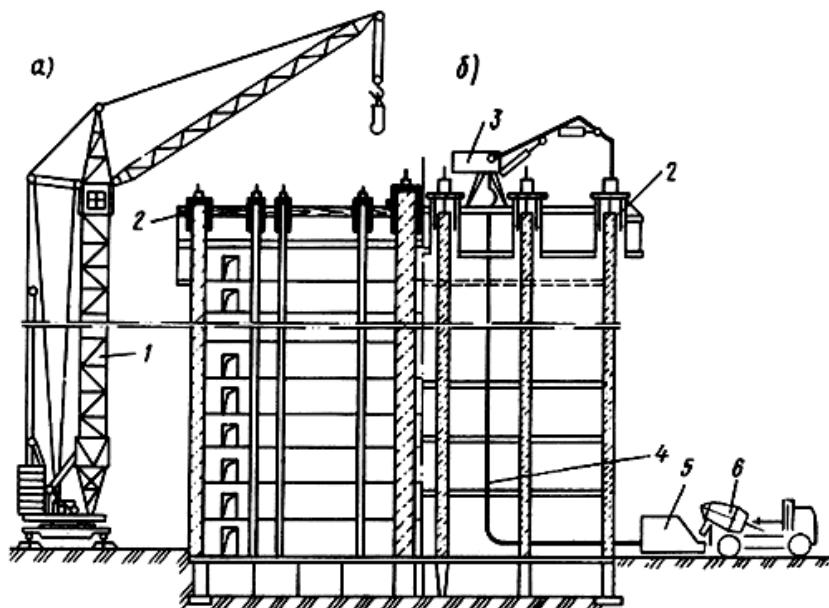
Схема возведения здания в скользящей опалубке с подачей смеси на высоту
